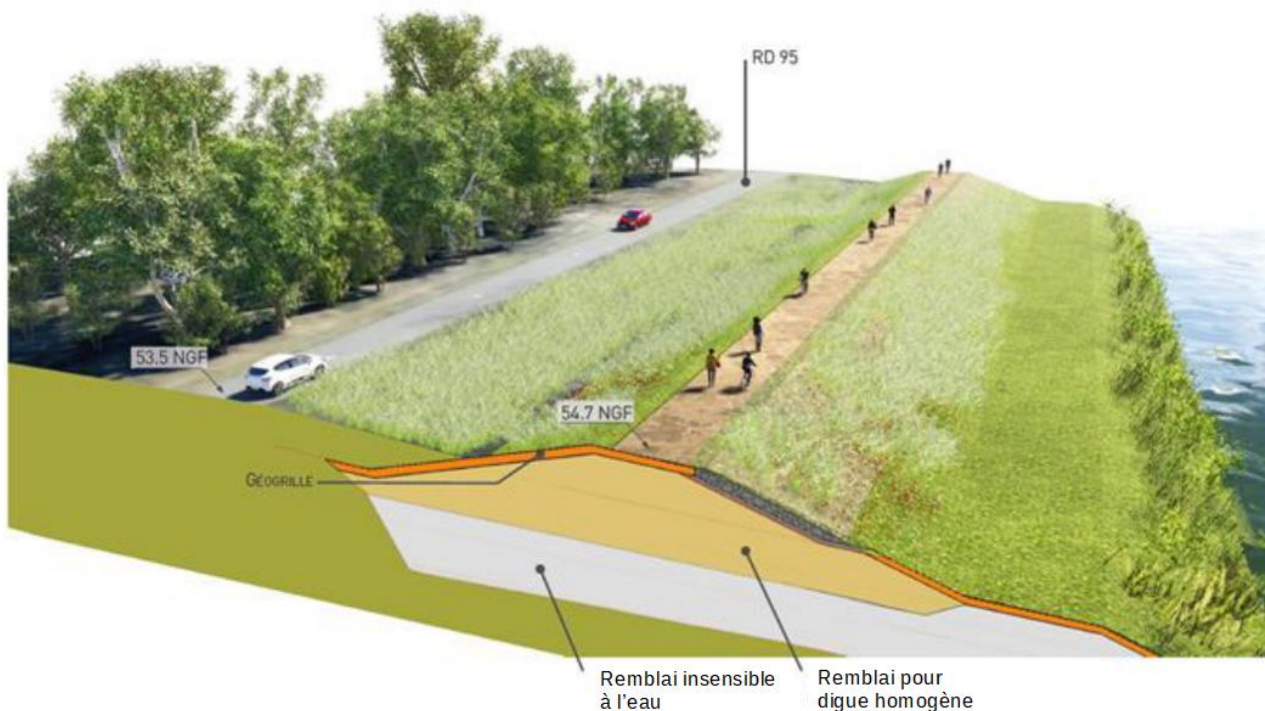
Digue en section courante (au niveau d'un étang existant)
